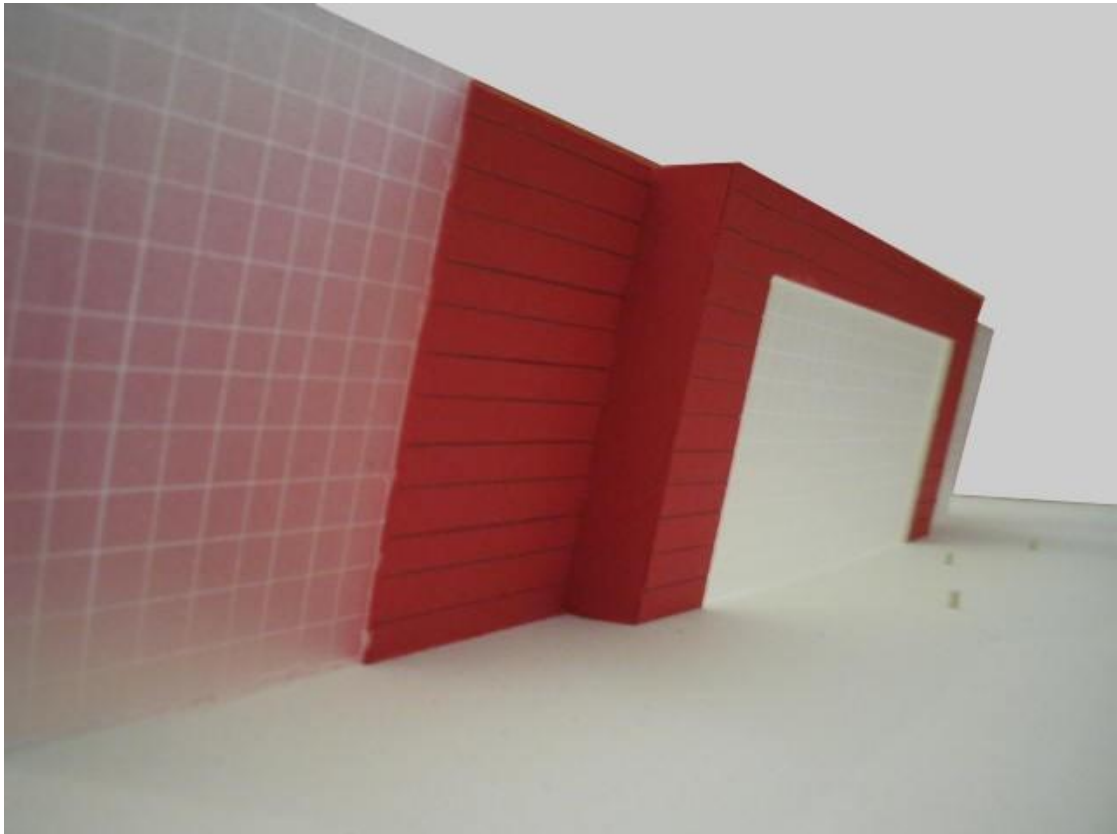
Maqueta estadio, fachada principal (este)
